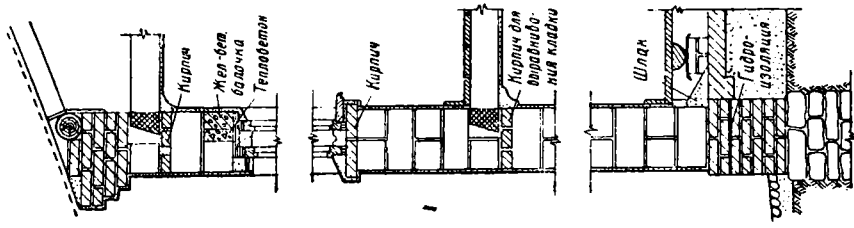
Система кладки кирпичных стен в 2 кирпича
